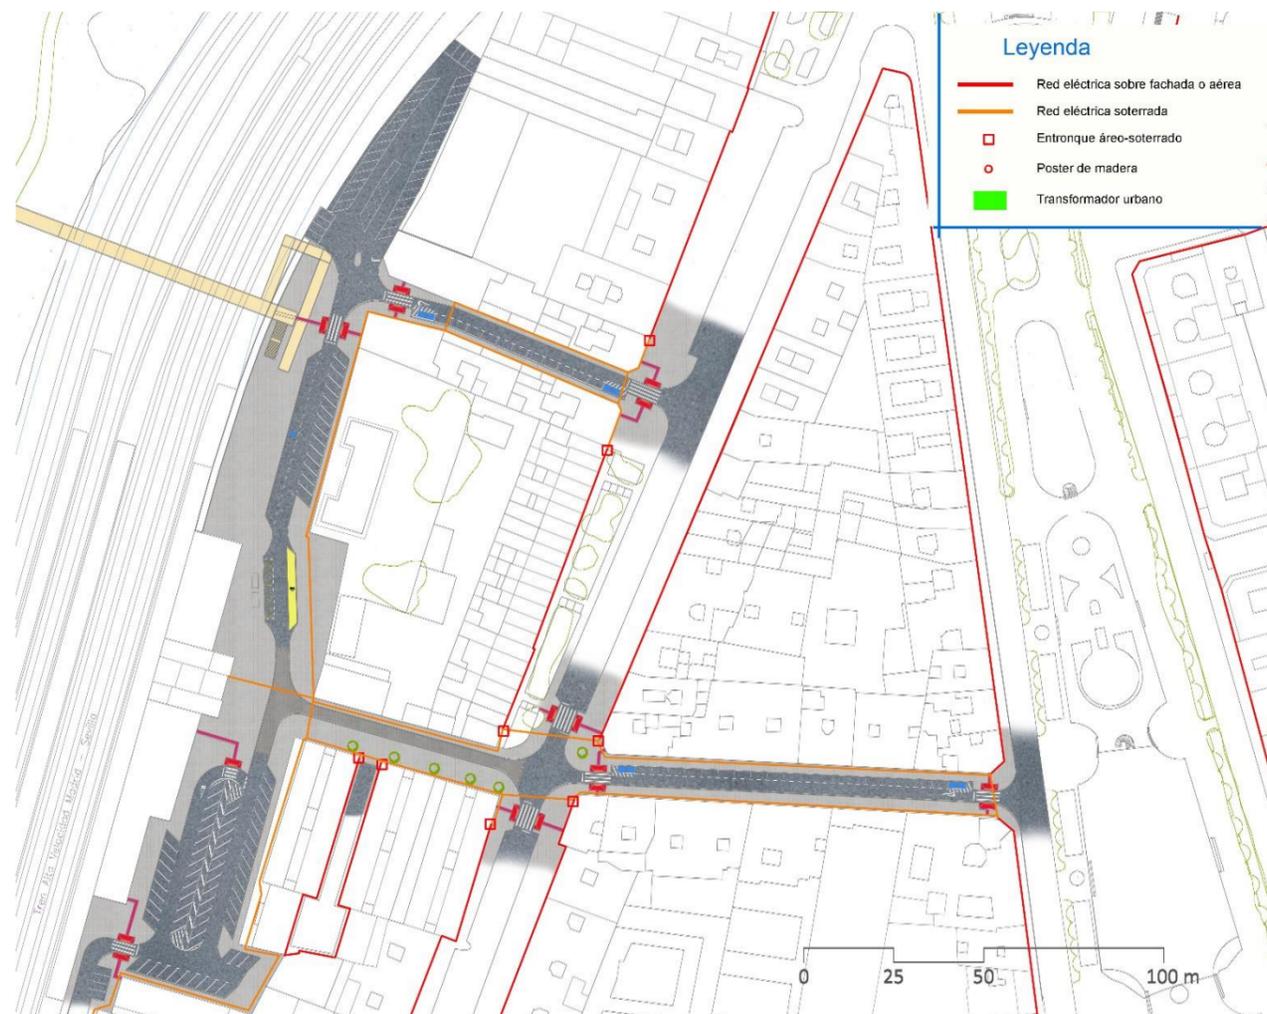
Distribución propuesta de la red eléctrica. Fuente: Elaboración Propia.
